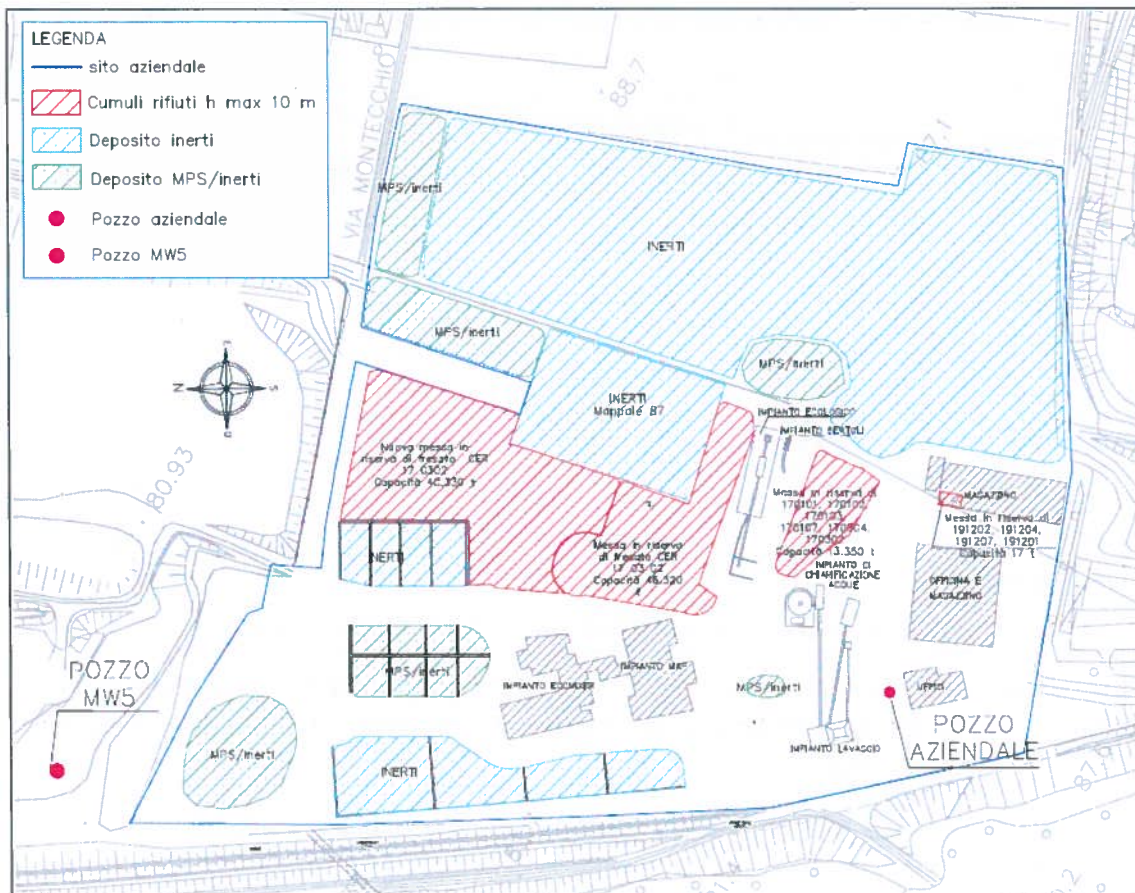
Planimetria del sito con indicazione dell'ubicazione del pozzo aziendale.
